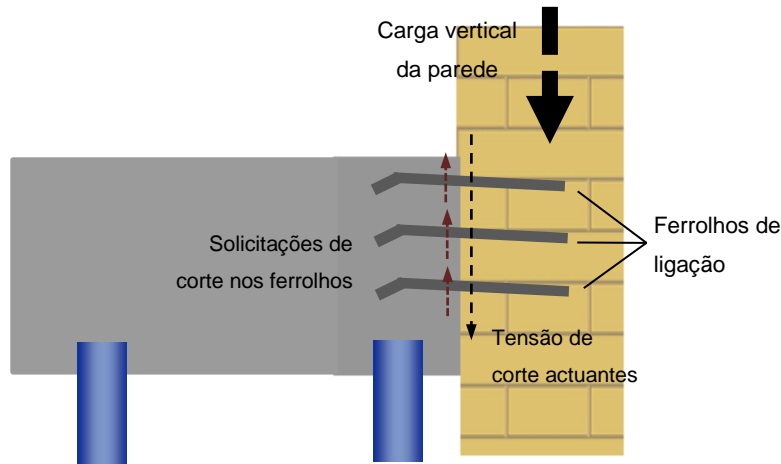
ESQUEMA DE LIGAÇÃO ENTRE PAREDE E VIGA DE RECALÇAMENTO RECORRENDO A FERROLHOS.
